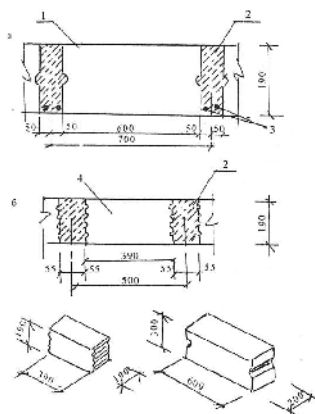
Сборно - монолитные перекрытия с использованием межкаркасных элементов: а - фрагмент схемы сборно - монолитного перекрытия; б - элемент межблочного заполнения; 1 - лачисто - бетонный блок; 2 - монолитная балка; 3 - арматура; 4 - бетонный блок
